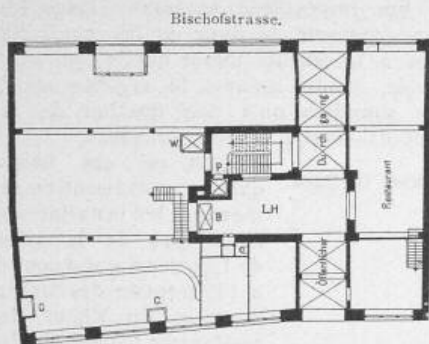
Erdgeschoss-Grundriss 1:500.
